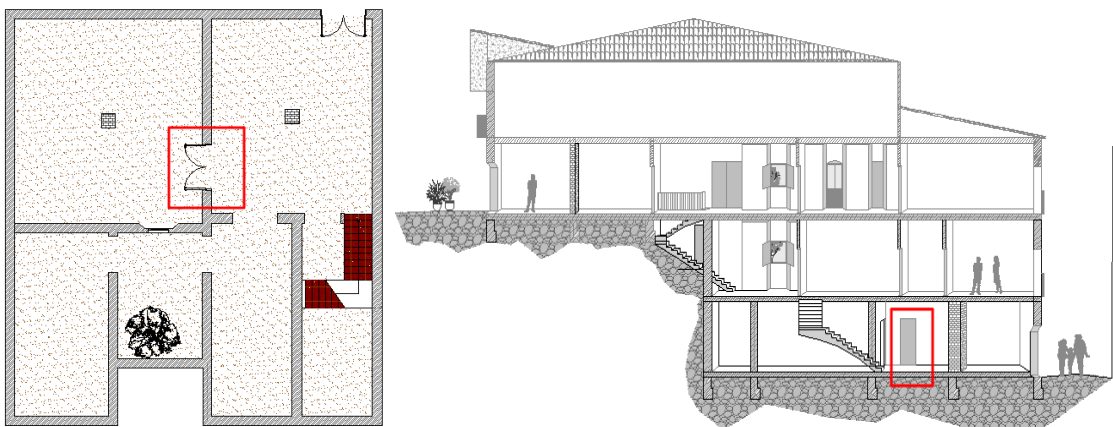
Plànols Secció i Planta . Planta Semi Soterrada 2.
